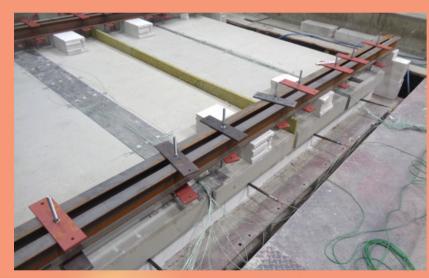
Ein alternativer Prüfaufbau im horizontalen Prüfstand für Bauteilfugen mit mechanisch induzierter Bewegung
